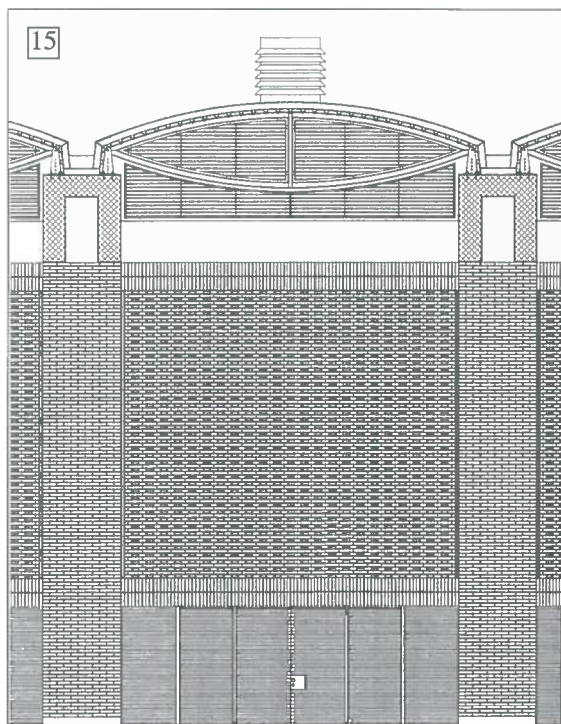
Centro sportivo, Tenero. Sezione longitudinale di una campata del portico sud
